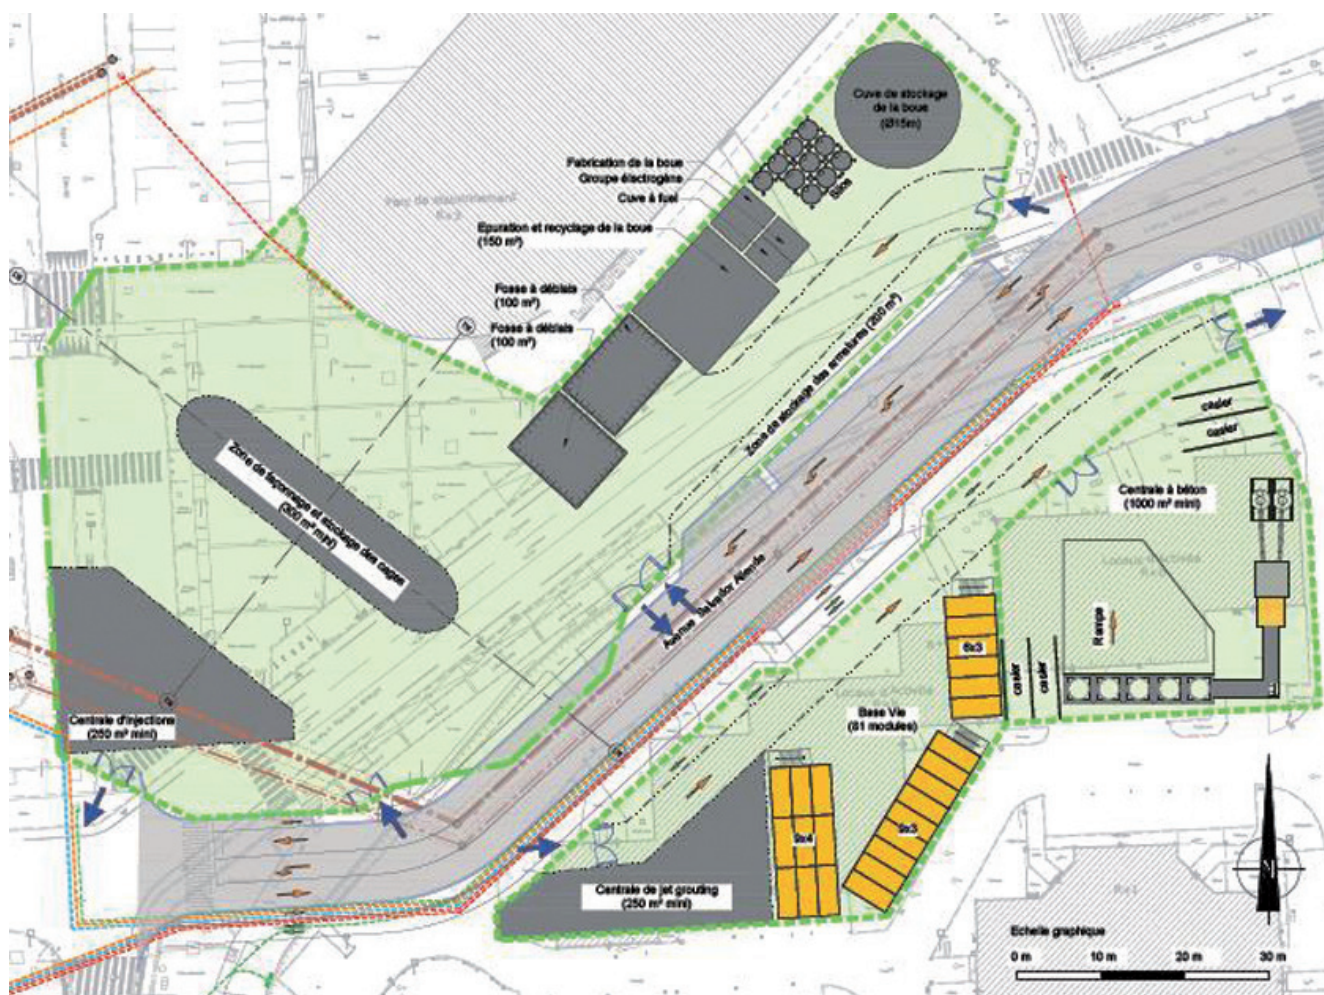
Vue en plan – Emprise pendant les travaux de la boîte profonde
